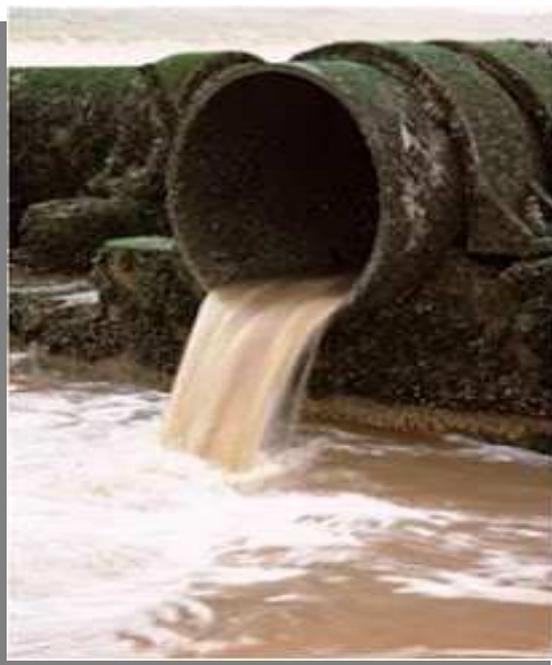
Tubulações em barro vidrado utilizadas em sistemas de esgotamento sanitário
